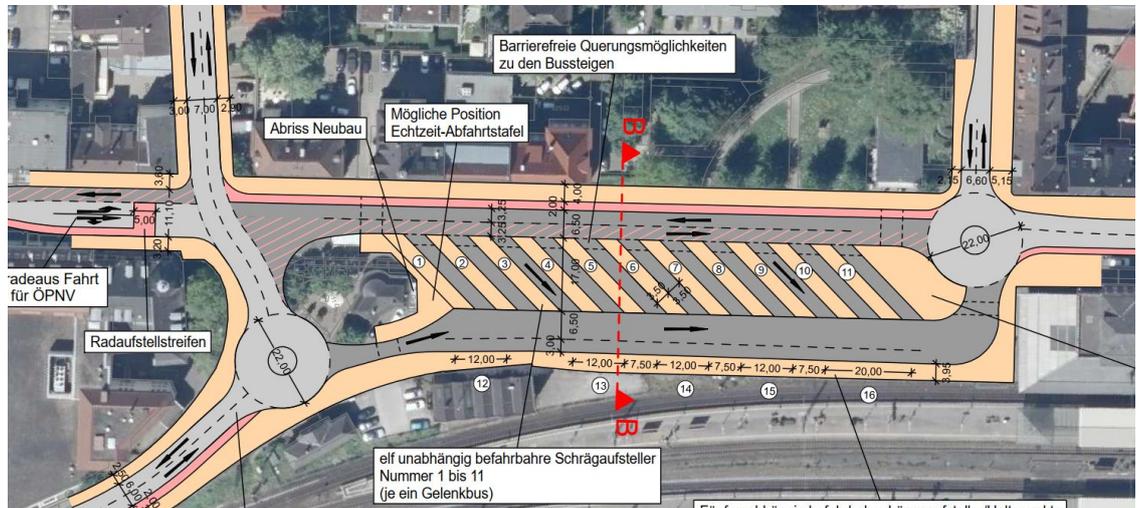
Ausschnitt Lageplan Südvergrößerung 2
